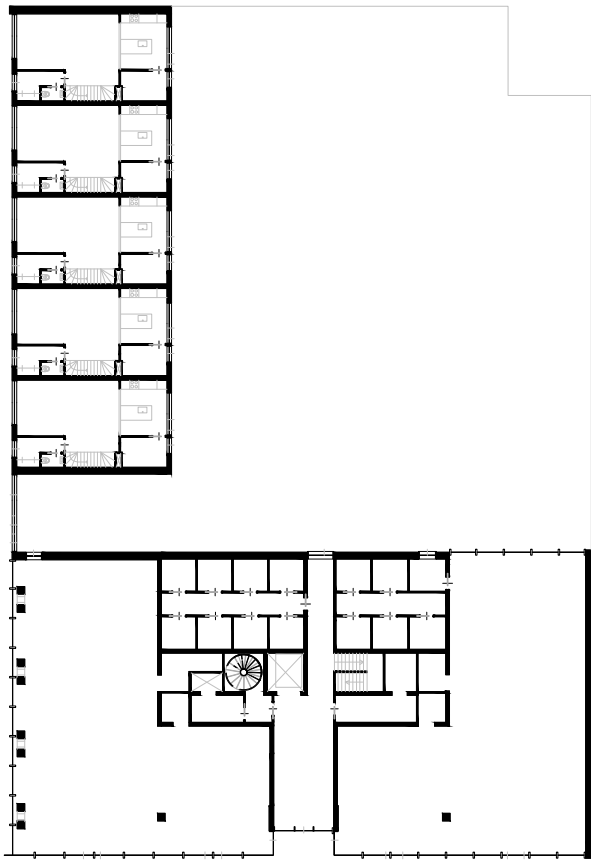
Plano de planta baja del edificio Patch 22 a escala 1: 500
